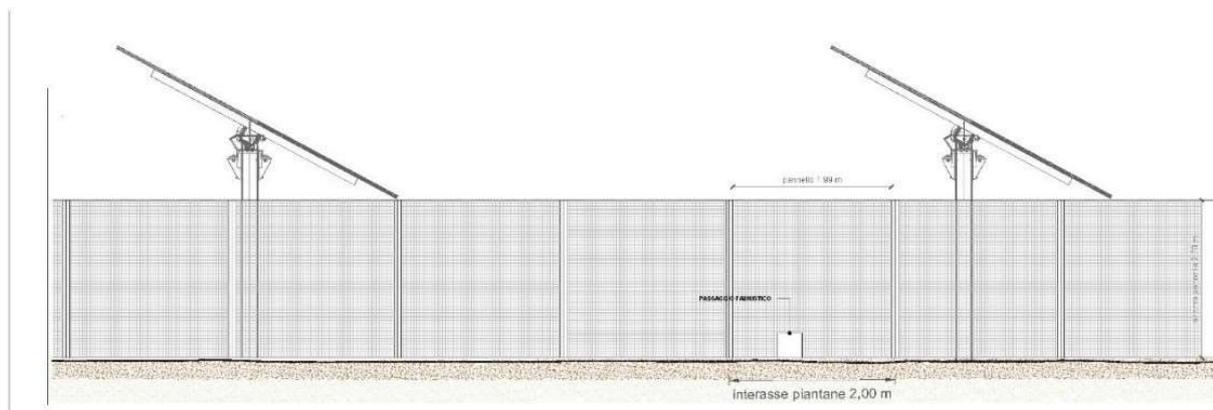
Prospetto recinzione perimetrale senza mitigazione
